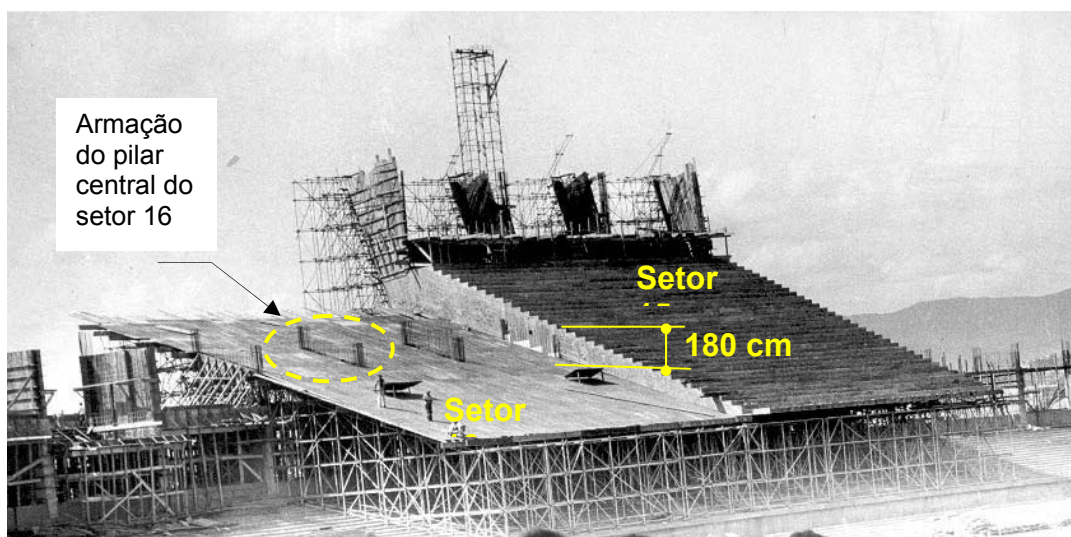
Setor 15 com a arquibancada já concretada segundo a geometria original. Do lado esquerdo, observa-se a forma inferior da laje feita em madeirite para a execução do setor 16, que ainda está com a mesma inclinação da face inferior da viga do setor 15
